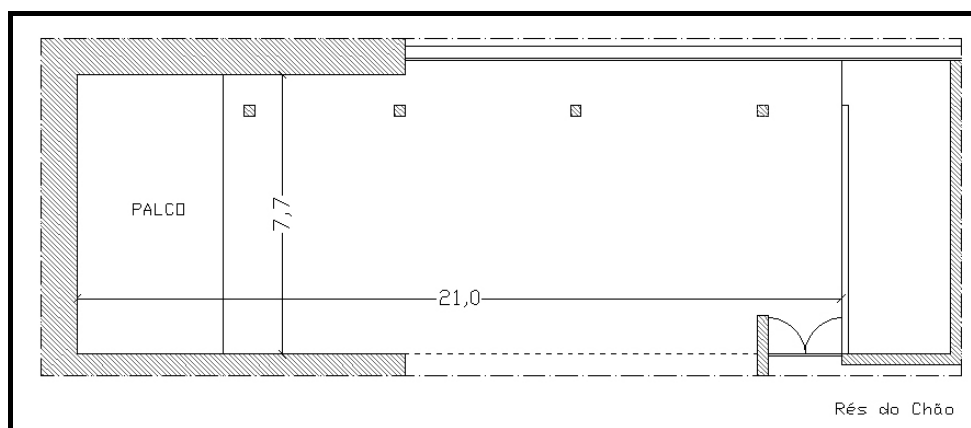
Planta do Café-Concerto do Centro Cultural Vila Flôr
